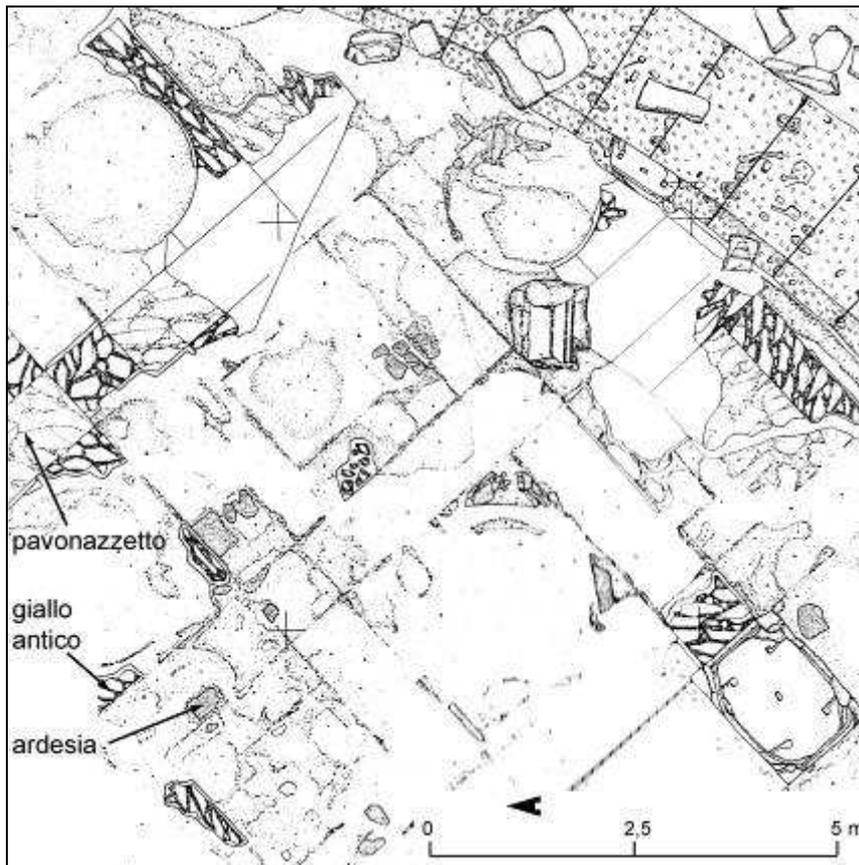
Roma. Foro di Traiano. Particolare della pianta della pavimentazione dell'abside orientale, con i resti della pavimentazione in *opus sectile* e le impronte delle lastre mancanti nello strato di preparazione. Nella malta si conservano i tasselli di ardesia che erano applicati sul retro delle lastre (PACKER 1997, rilievo M. Bianchini, R. Di Re – Studio Tau)
